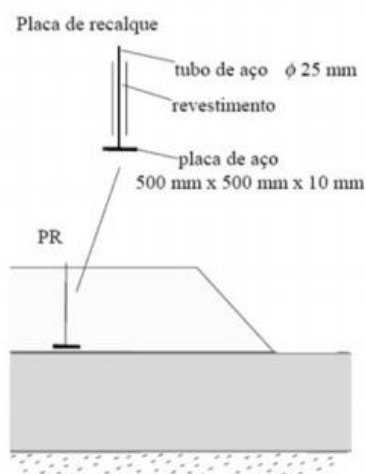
Esquema de posicionamento e detalhe de placa de recalque
